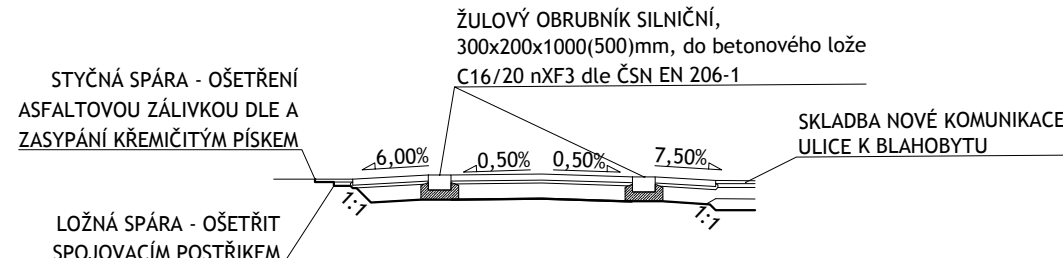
DETAIL PŘEJEZDNÉHO PRAHU M1:100
